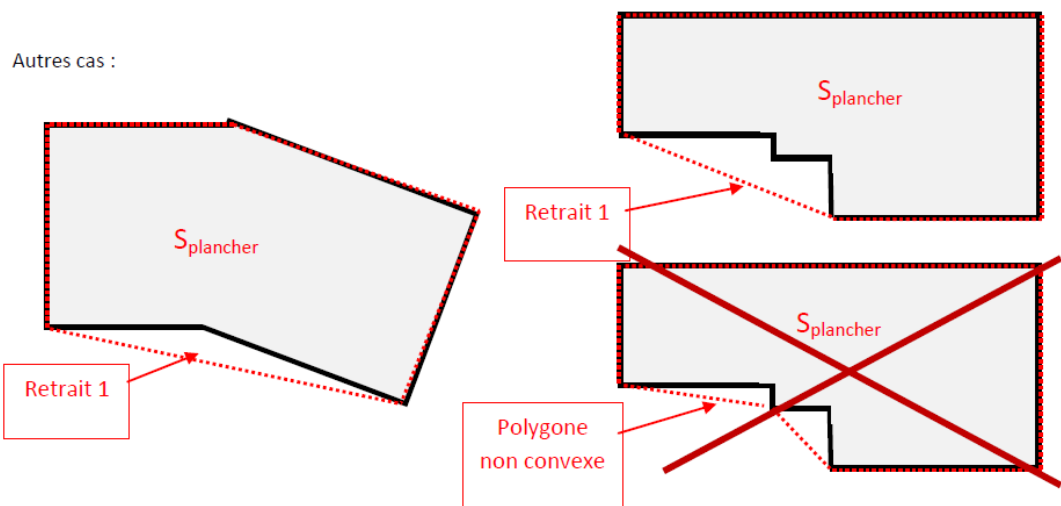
Critère b - Exemple d'application (autres cas)
